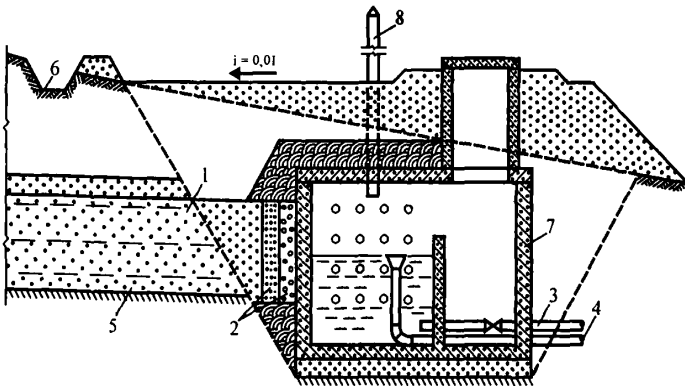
Конструкція каптажної камери спадного джерела: 1 — водонесний горизонт; 2 — зворотній гравійно-піщаний фільтр; 3 — водозабірна труба; 4 — переливна труба; 5 — водоупір; 6 — дренажна канава; 7 — залізобетонна каптажна камера, 8 — вентиляційний стояк.
